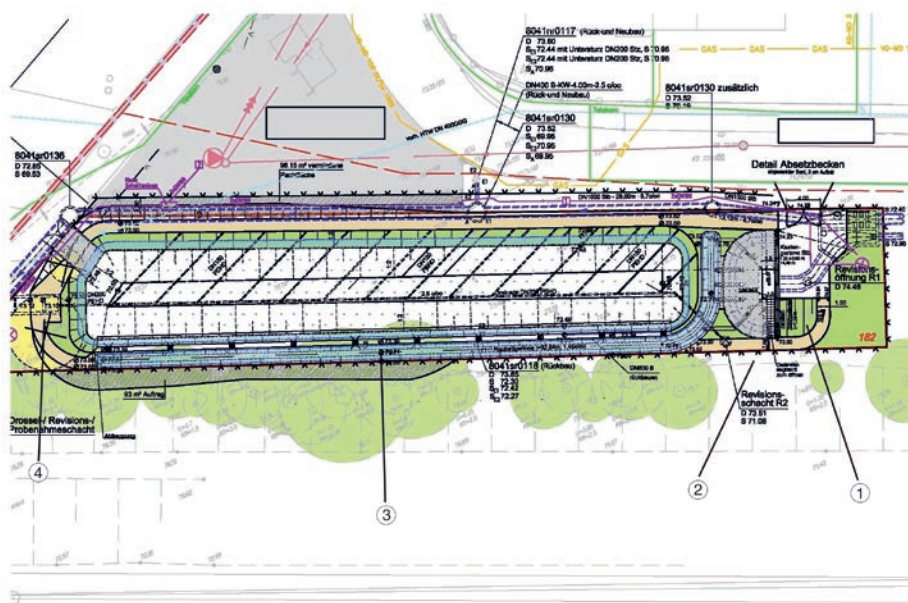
Lageplanausschnitt des Retentionsbodenfilters
